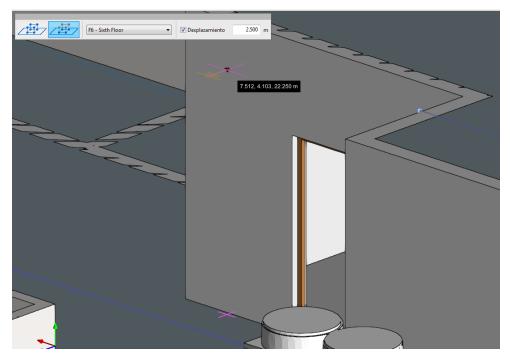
Introducción de un componente con desplazamiento sobre el plano de trabajo (Open BIM Lightning)
